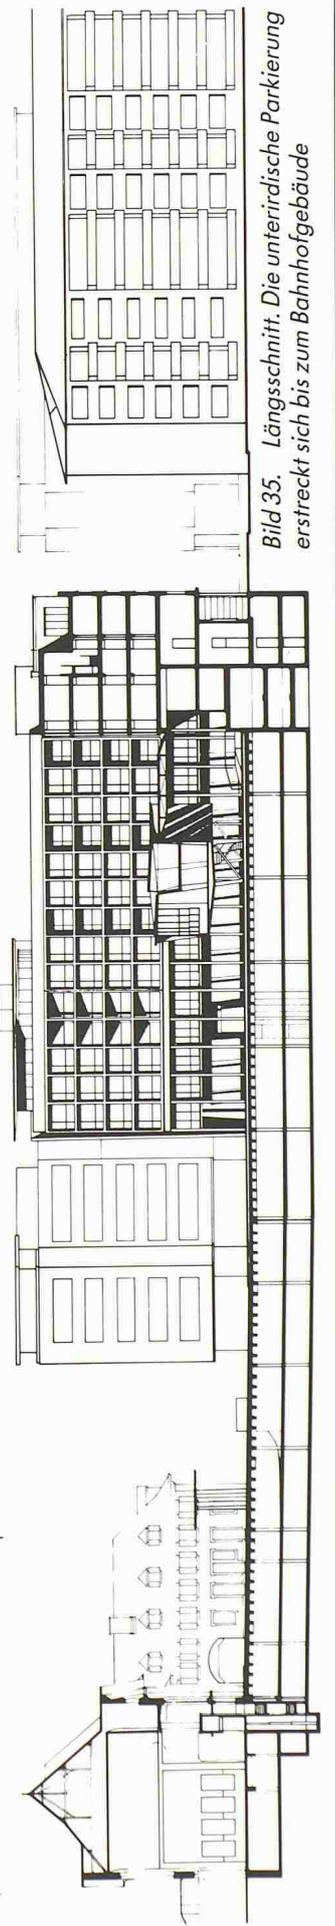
Längsschnitt. Die unterirdische Parkierung erstreckt sich bis zum Bahnhofgebäude
